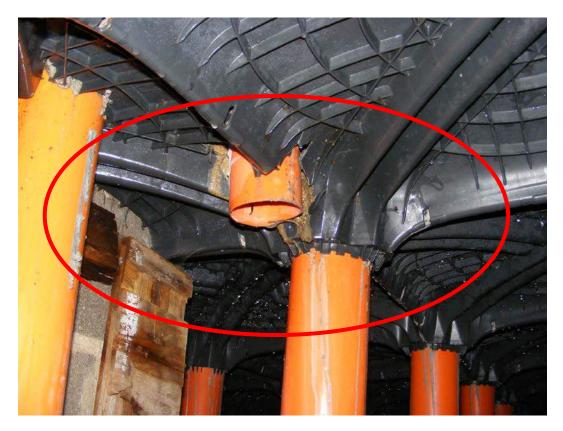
Vista dall'interno del vespaio del tubo di scarico proveniente dalla canaletta
